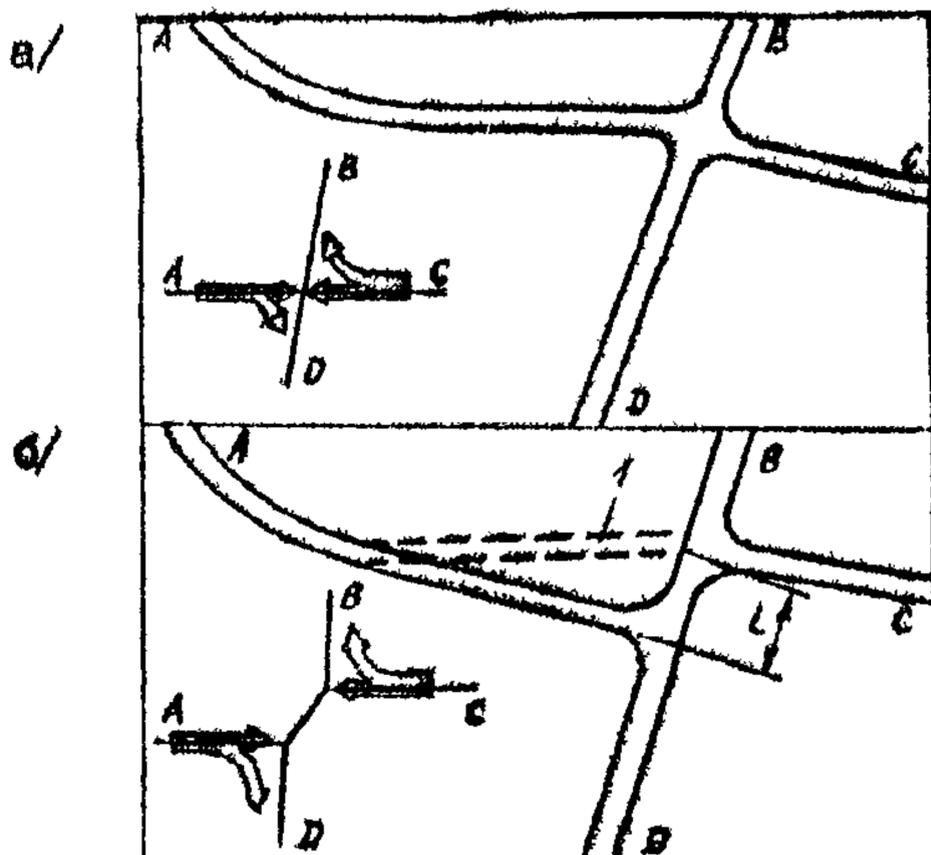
Перестройка пересечения на два смещенные примыкания: а - первоначальная планировка; б - планировка после реконструкции; I - закрытый участок дороги; в левых нижних углах показаны эшеры грузопотоков.
